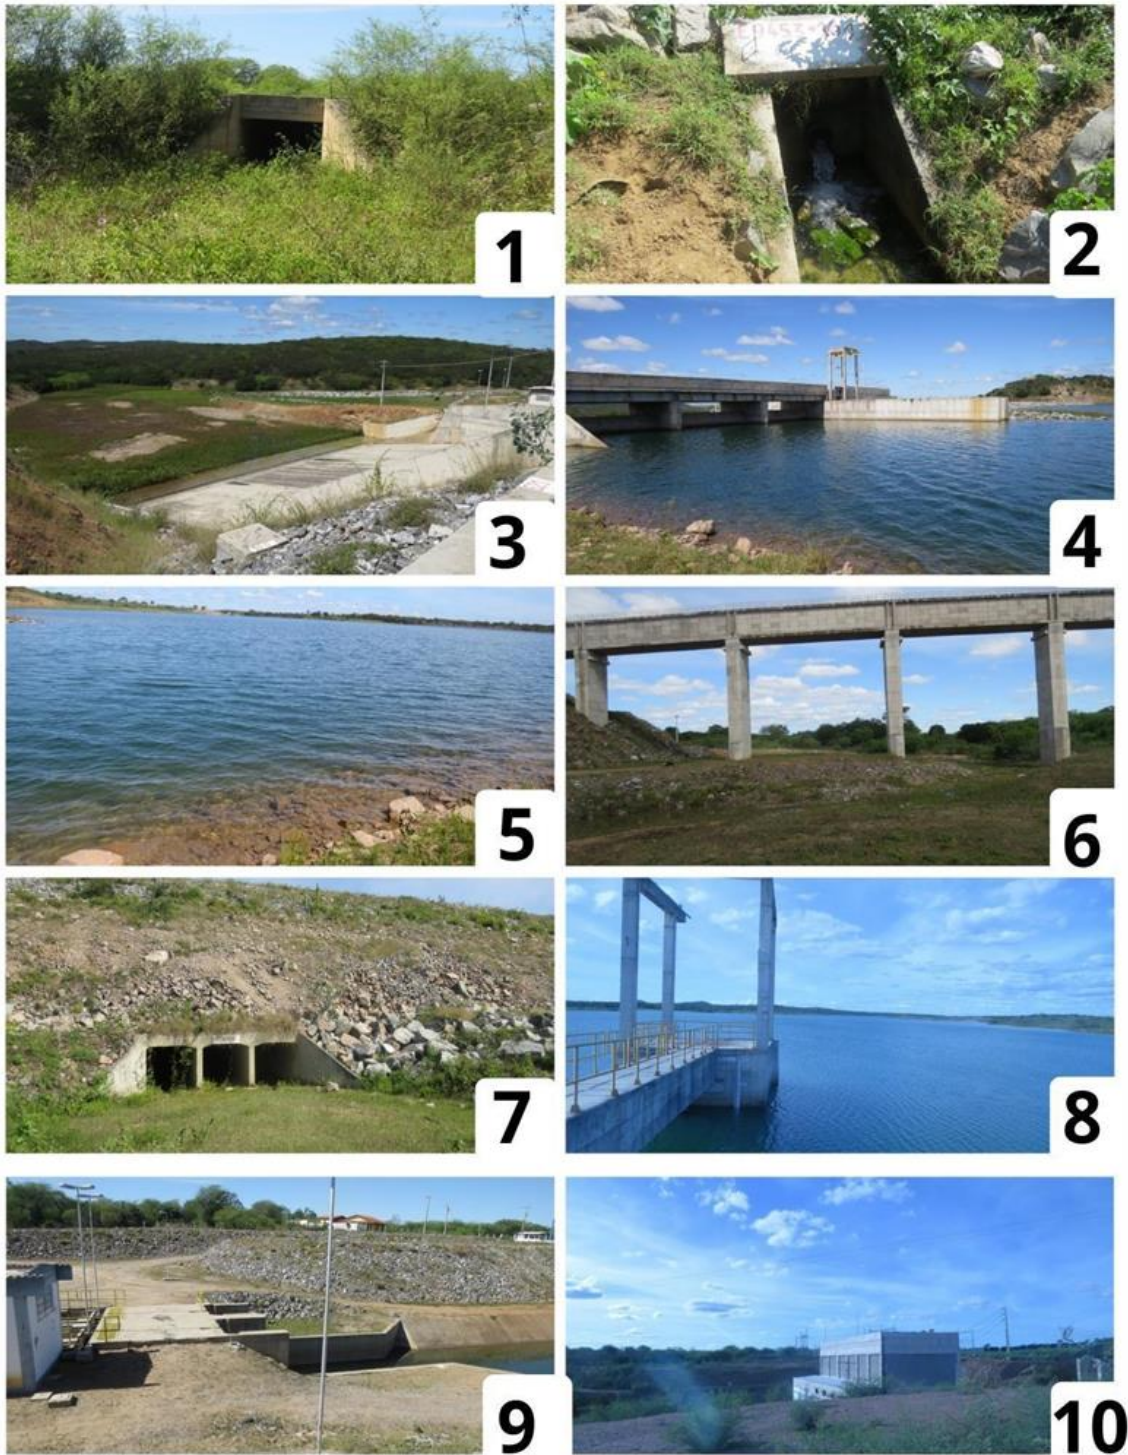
Nome de cada estrutura: 1 Túnel; 2 Saída de água concretada; 3 Barragem de comporta; 4 Comporta de saída de barramento; 5 Reservatório; 6 Aqueduto; 7 Passagem de água concretada; 8 Barramento; 9 Estação de bombeamento; 10 Estação elevatória. Autoral, (2024).
